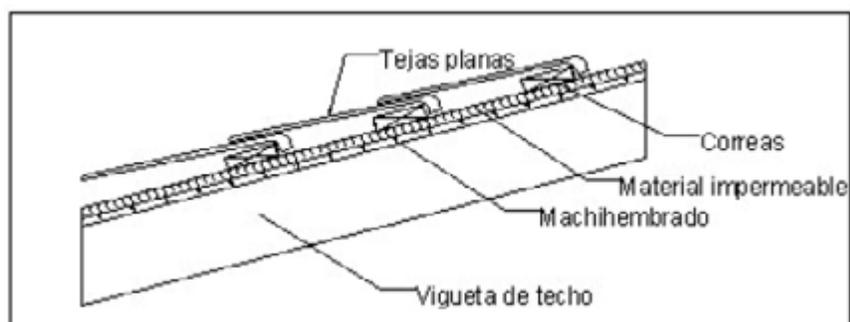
CUBIERTAS DE TEJA CERAMICA
